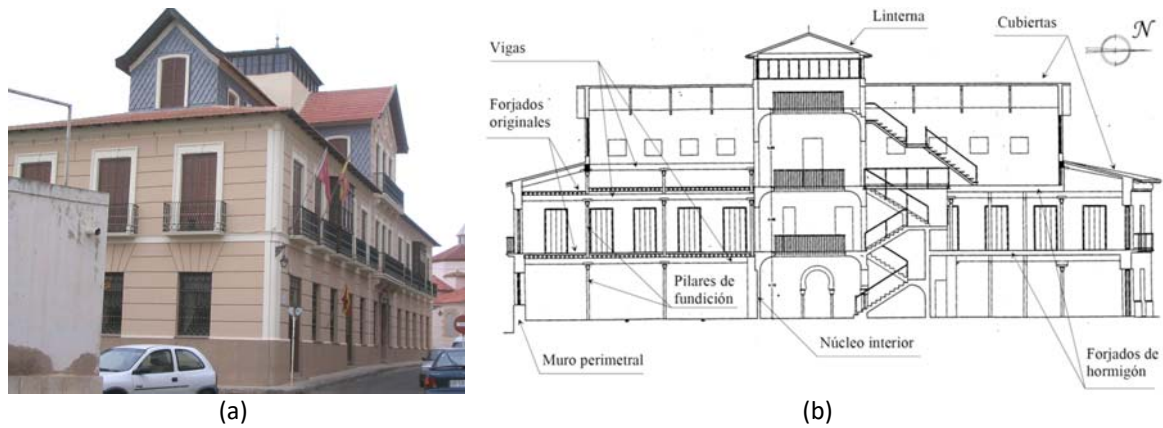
Casa Rubio. (a) Vista Sureste. (b) Sección Norte-sur.
